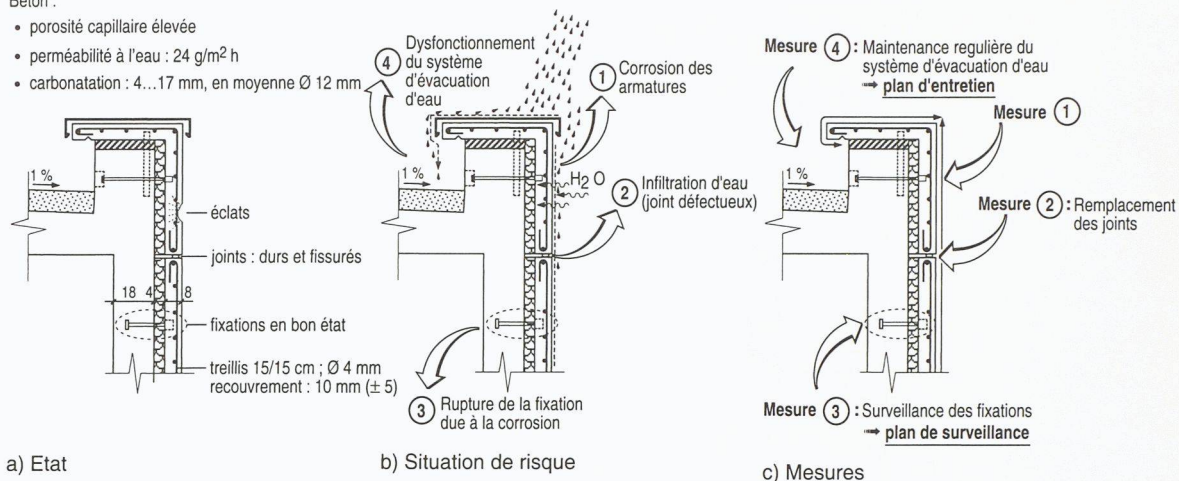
Eléments de façade en béton apparent : a) état, b) situations de risque, c) mesures
